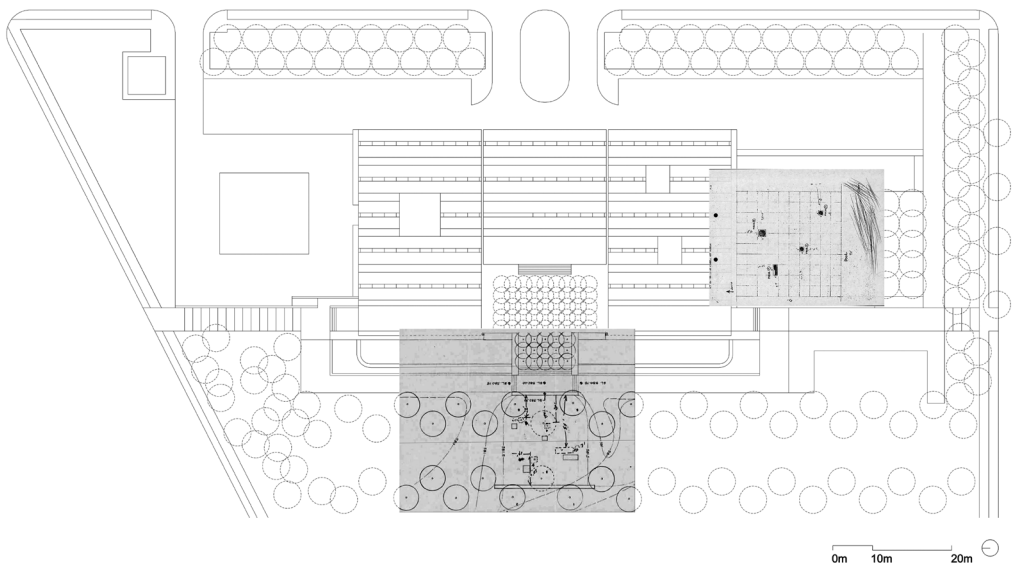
Fotomontaje sobre la planta del Museo Kimbell de las plantas de las dos ubicaciones de la obra *Constellation*. Imagen de los autores.
